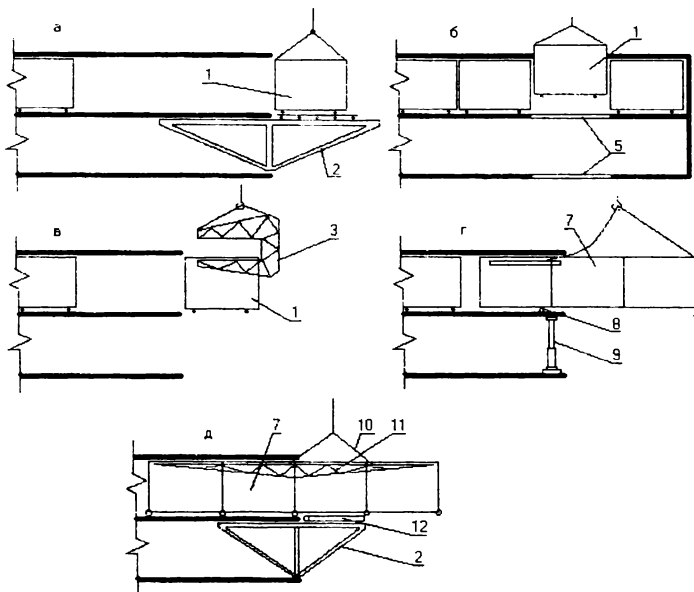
Схемы демонтажа объемно-переставной опалубки
